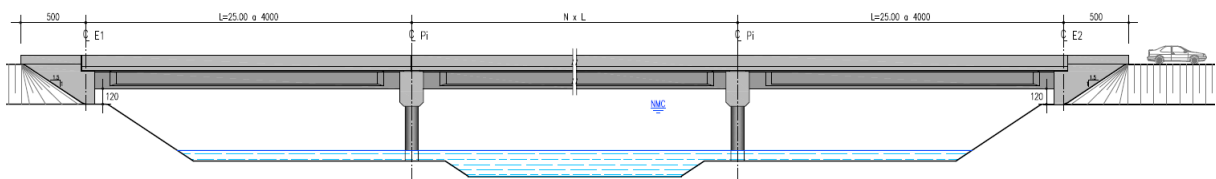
Obra de duplicação de vãos múltiplos. Elevação.
